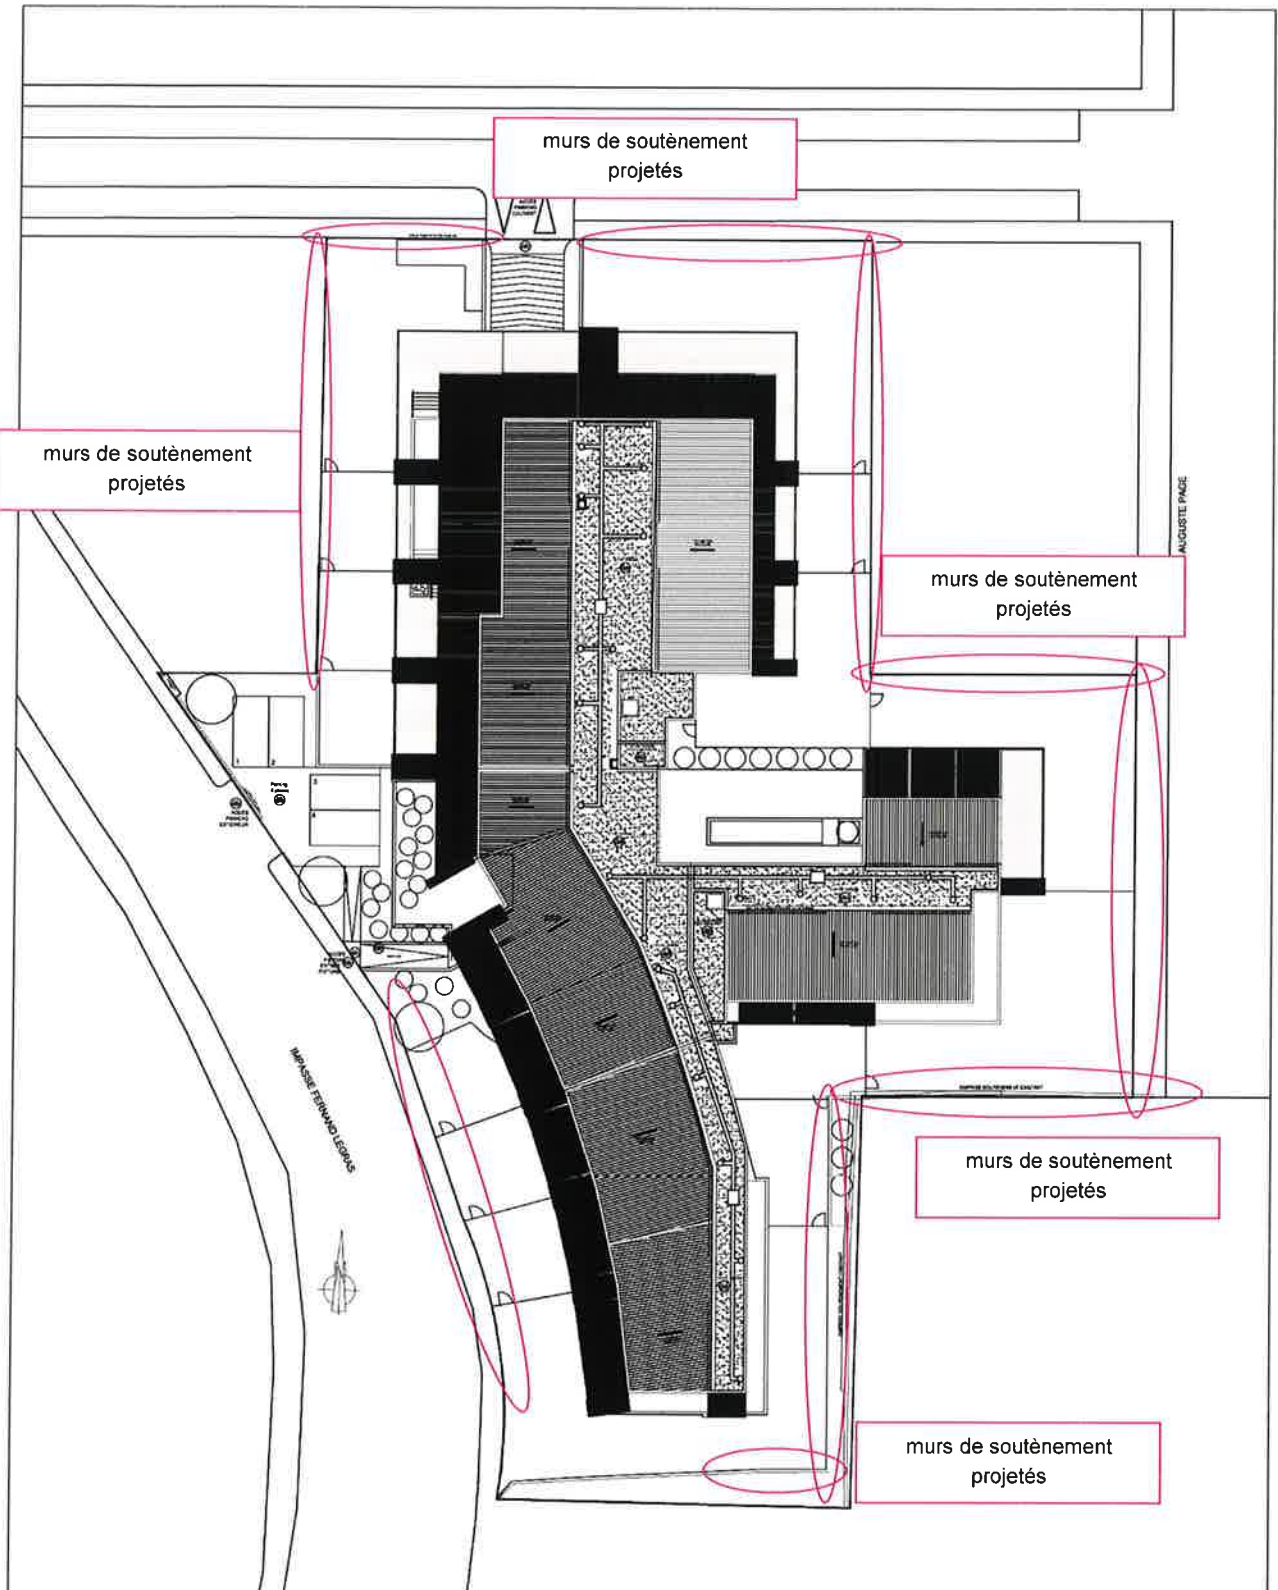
Emprise du projet (Plan reçu le 01/12/2020)
